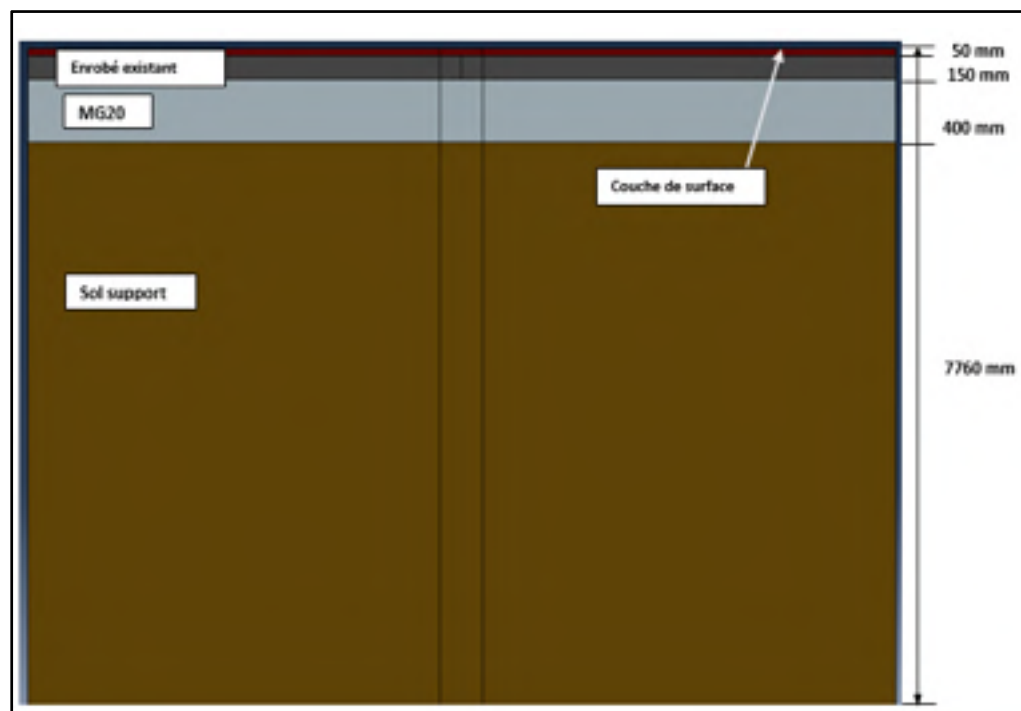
Structure réhabilitée par un planage-resurfaçage
